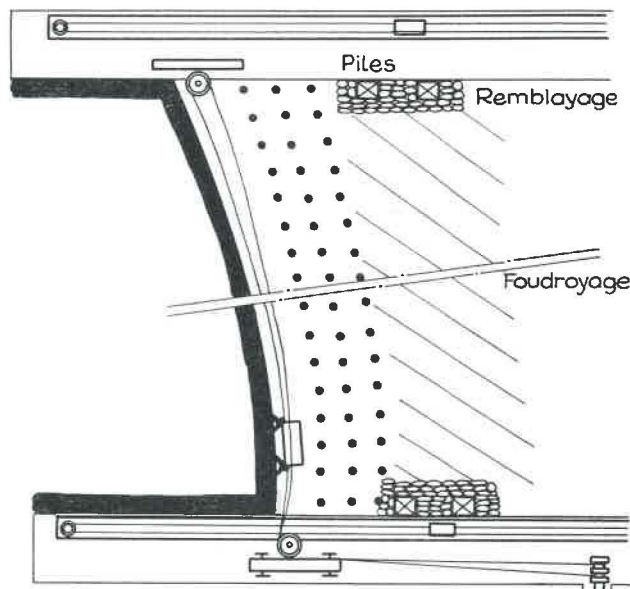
is. — Plan de la taille, Disposition actuelle.
